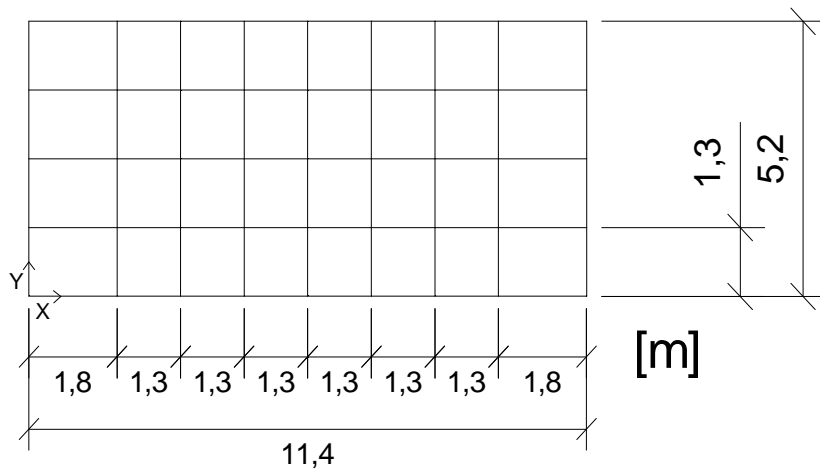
Vista em Planta de Um Plano Horizontal no Cembre ao Solo Para Uma Seção Tipo de Um Viaduto Com 20 m de Vão
